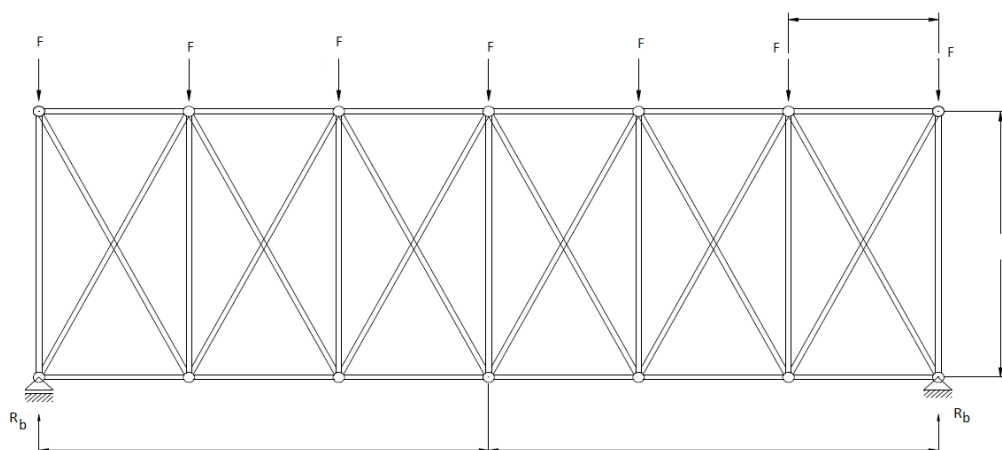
Configuração do sistema de contraventamentos em cruz de Santo André.(Gomes, 2019)
